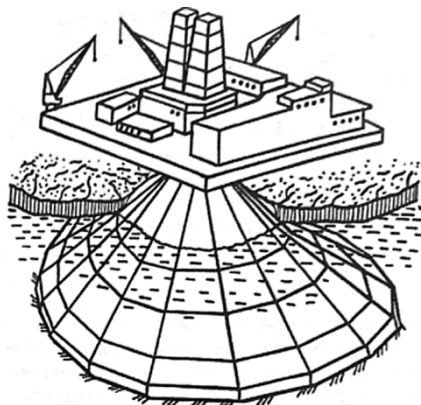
Платформа стальной конструкции на свайных основаниях для глубин 20–60 м [2]
